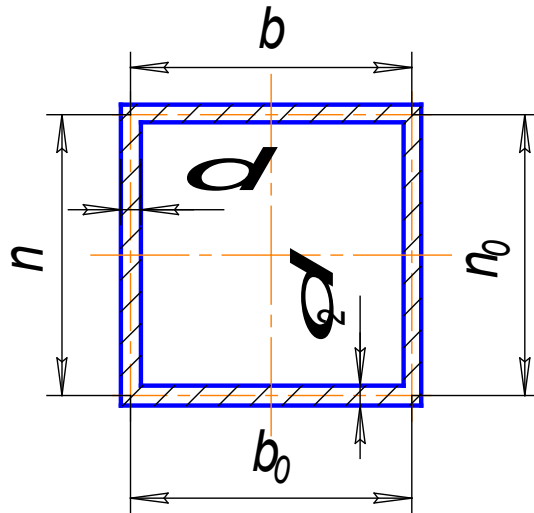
Розрахункова схема балки (поперечний переріз)
